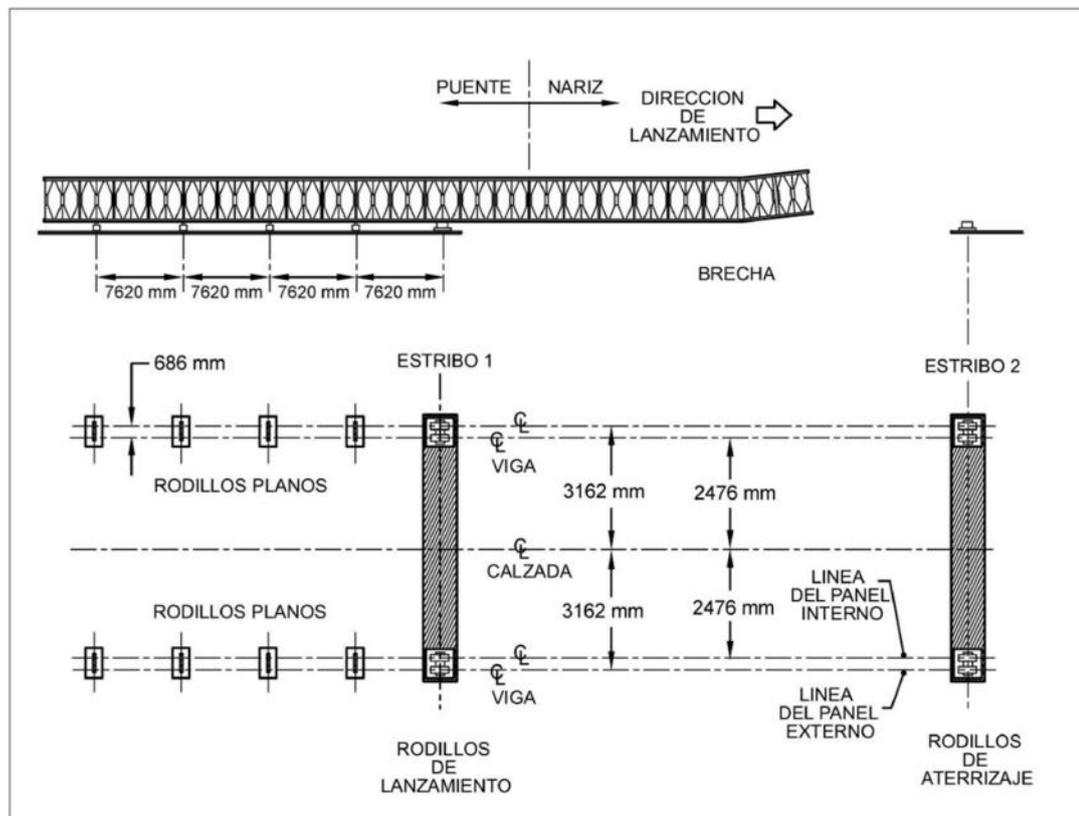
Disposición de los rodillos, antes de iniciar montaje de la estructura modular
